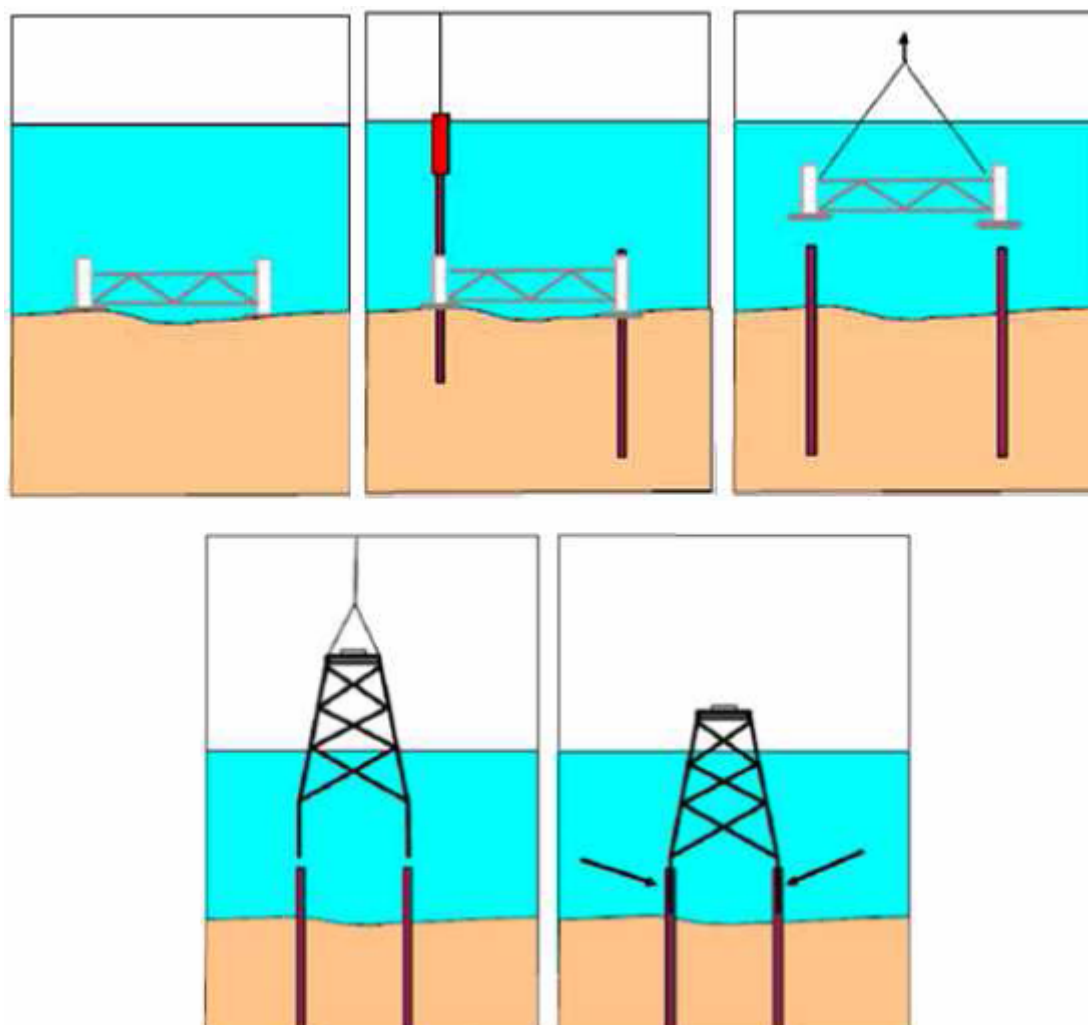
Installazione di jacket sui tubi fondari mediante meda ed intervento finale di grouting, come indicato dalle frecce
